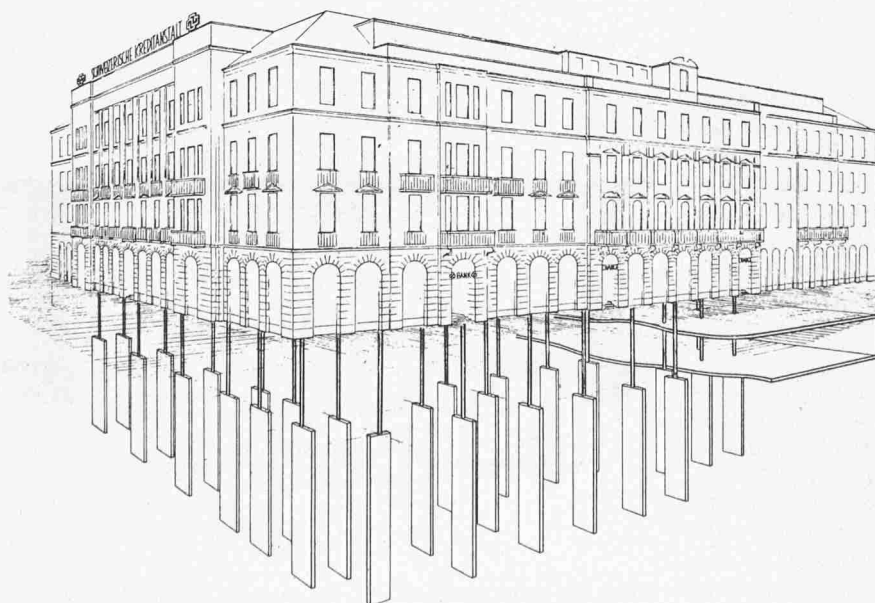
Schematische Darstellung des Schlitzpfahlverfahrens. Hauptfassade zur Bahnhofstrasse
